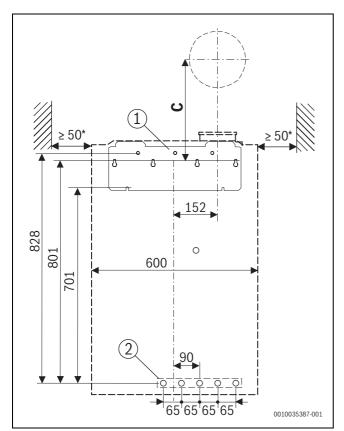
Frontansicht, horizontaler hydraulischer Anschluss(mm)
